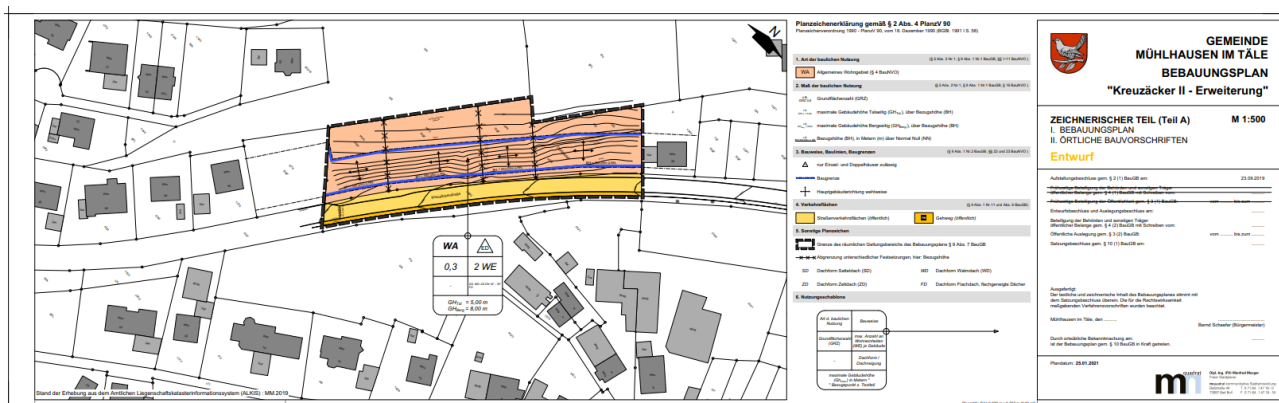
Vorentwurf Bebauungsplan vom 25.01.2021. Quelle: mquadrat
